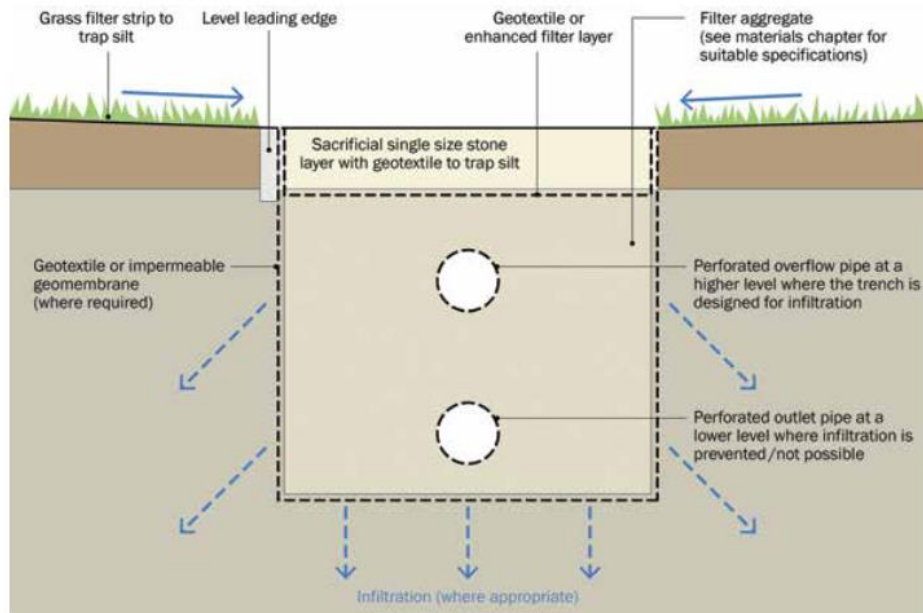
Corte transversal de uma trincheira de infiltração. Fonte: (Commitee, 1999)
